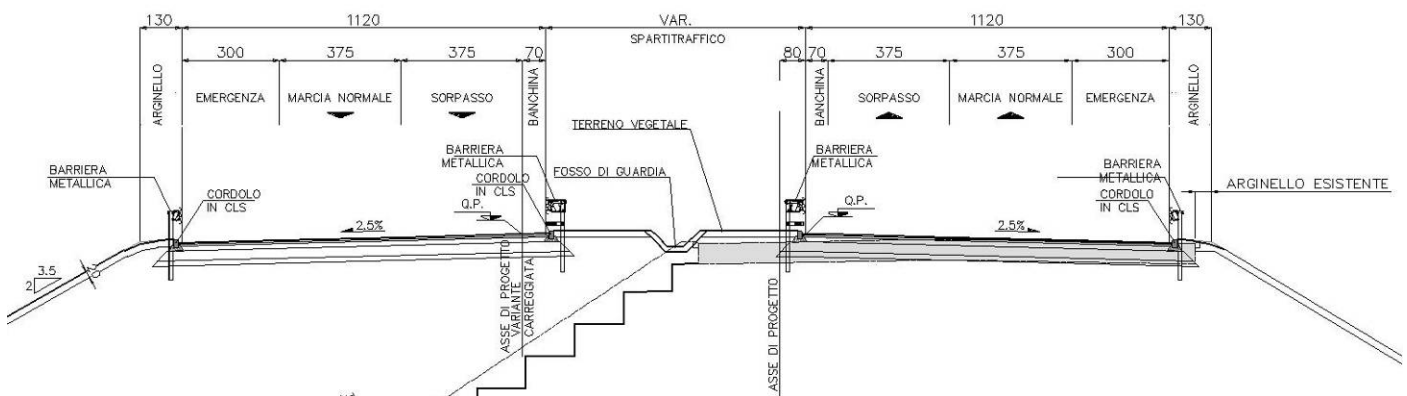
Sezione tipo di progetto con Carr. Nord in variante (adeguamento SS1 Aurelia)
